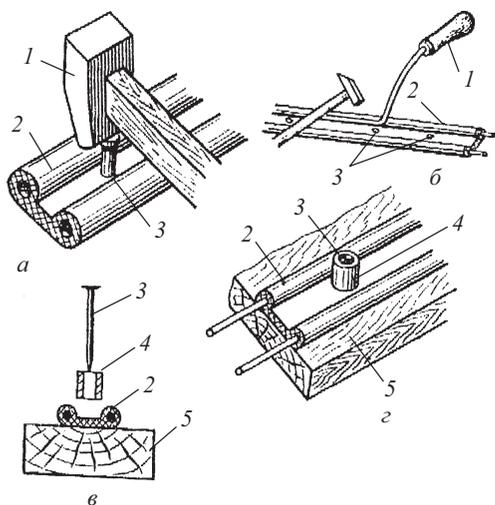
Предохранение плоских проводов от повреждений на монтаже:
